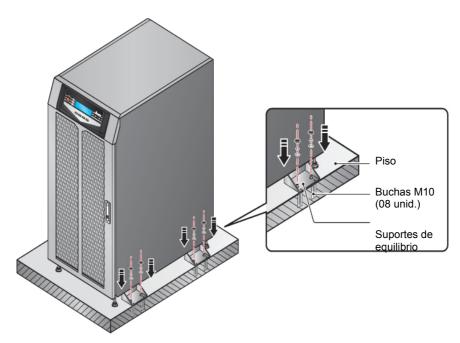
Fixando os suporte de equilíbrio ao solo
